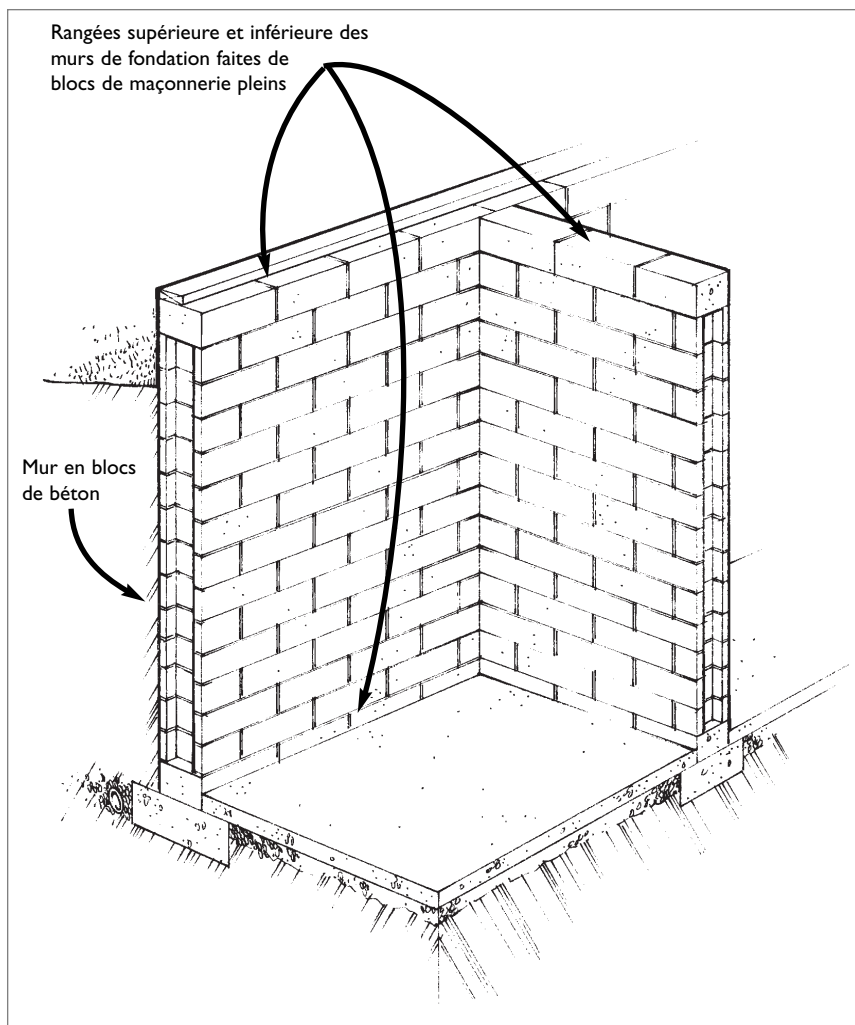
Élimination des cavités au haut et au bas des nouveaux murs de fondation en blocs de béton.
